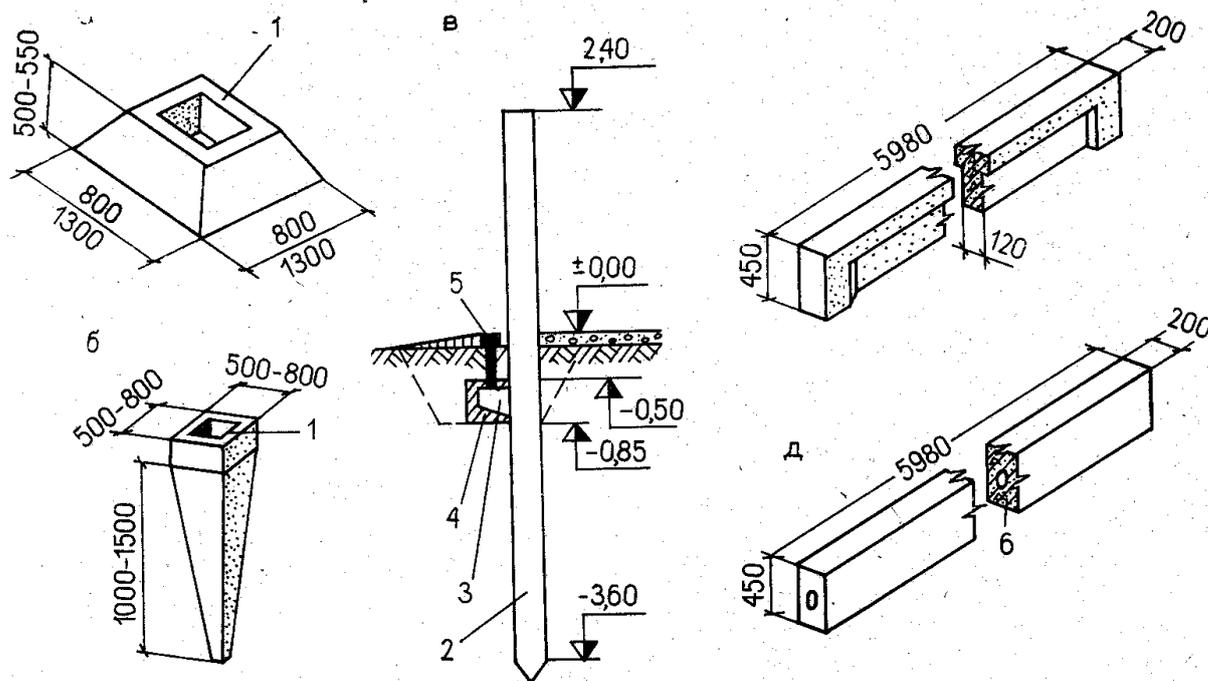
Сборные железобетонные конструкции подземной части сельскохозяйственных зданий:
